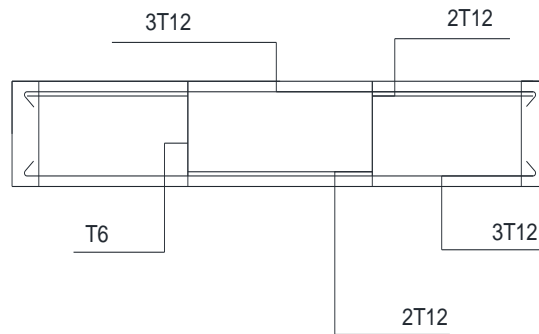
Coupe longitudinale d'une poutre secondaire 20x30cm (bâtiment R+3)
